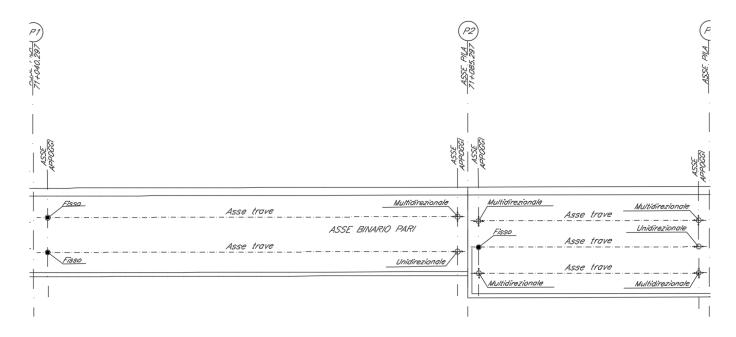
schema appoggi impalcati convergenti sulla pila.
